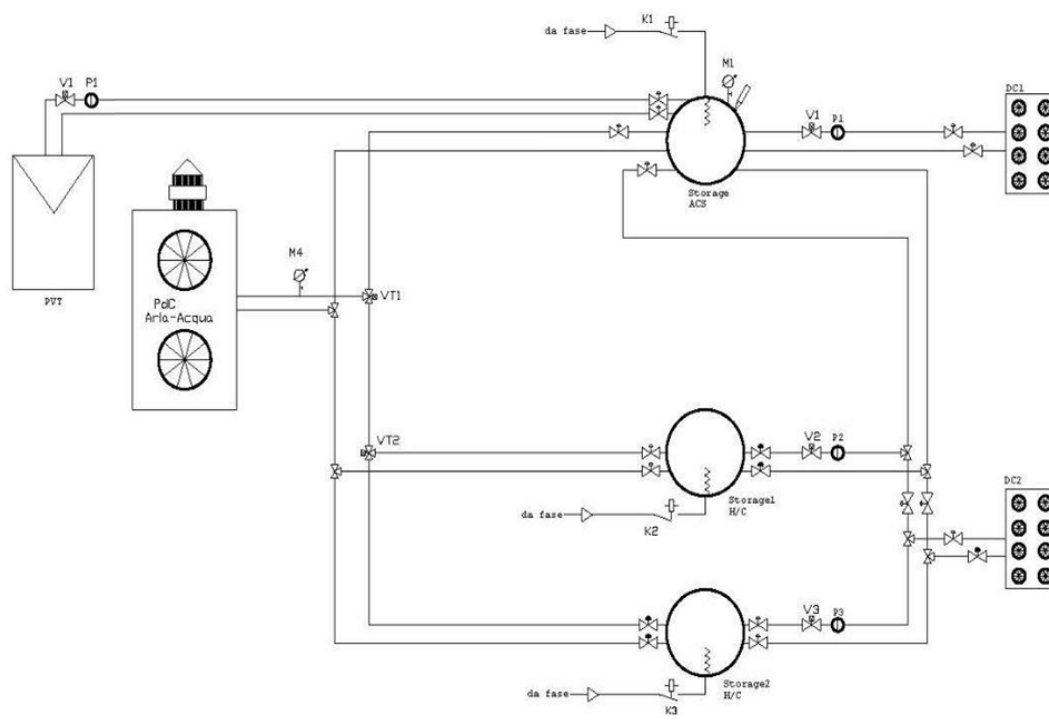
Rete S.A.P.I.EN.T.E. - layout impianto termico
